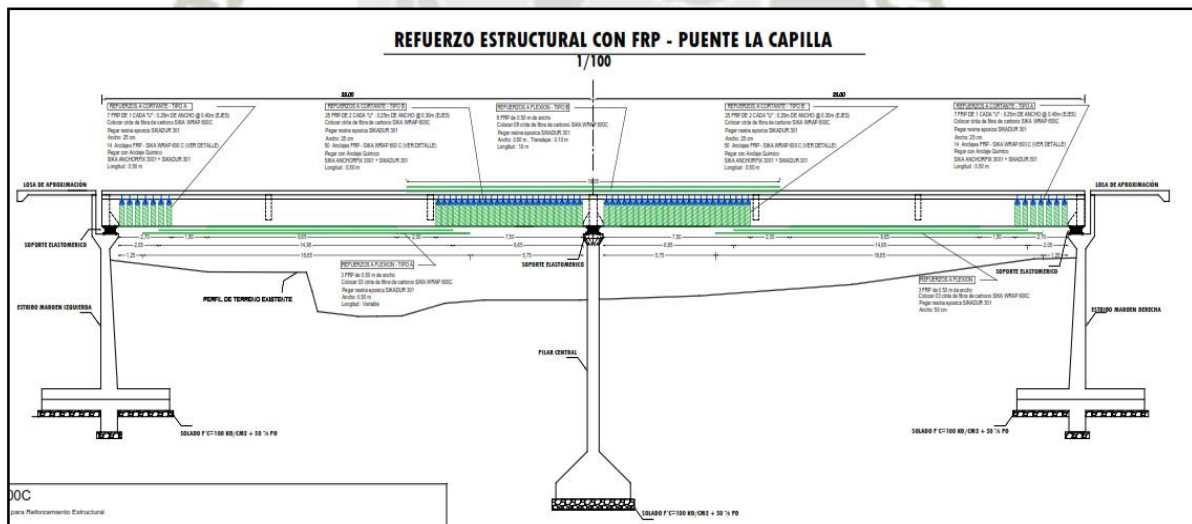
Detalle de reforzamiento tipo A para vigas principales.
